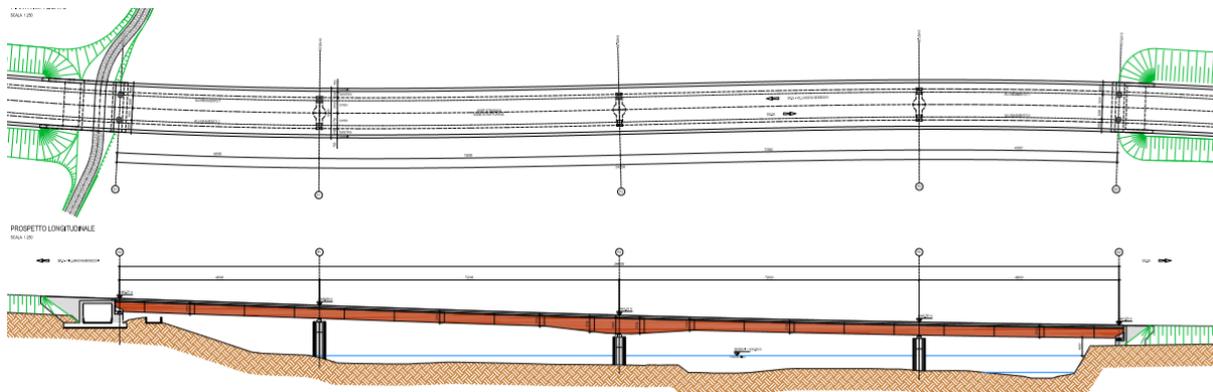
Viadotto Ellero - planimetria e profilo longitudinale
